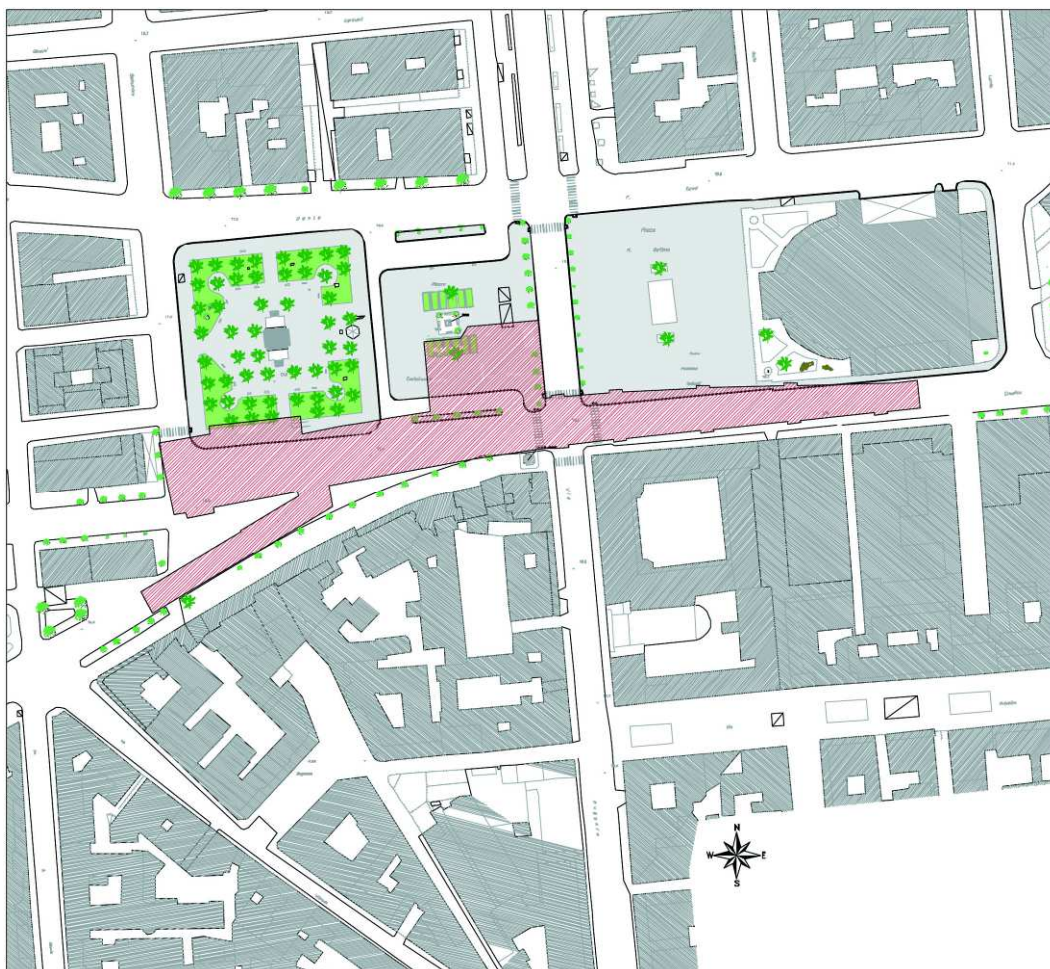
Planimetria d'inquadramento della stazione Politeama
